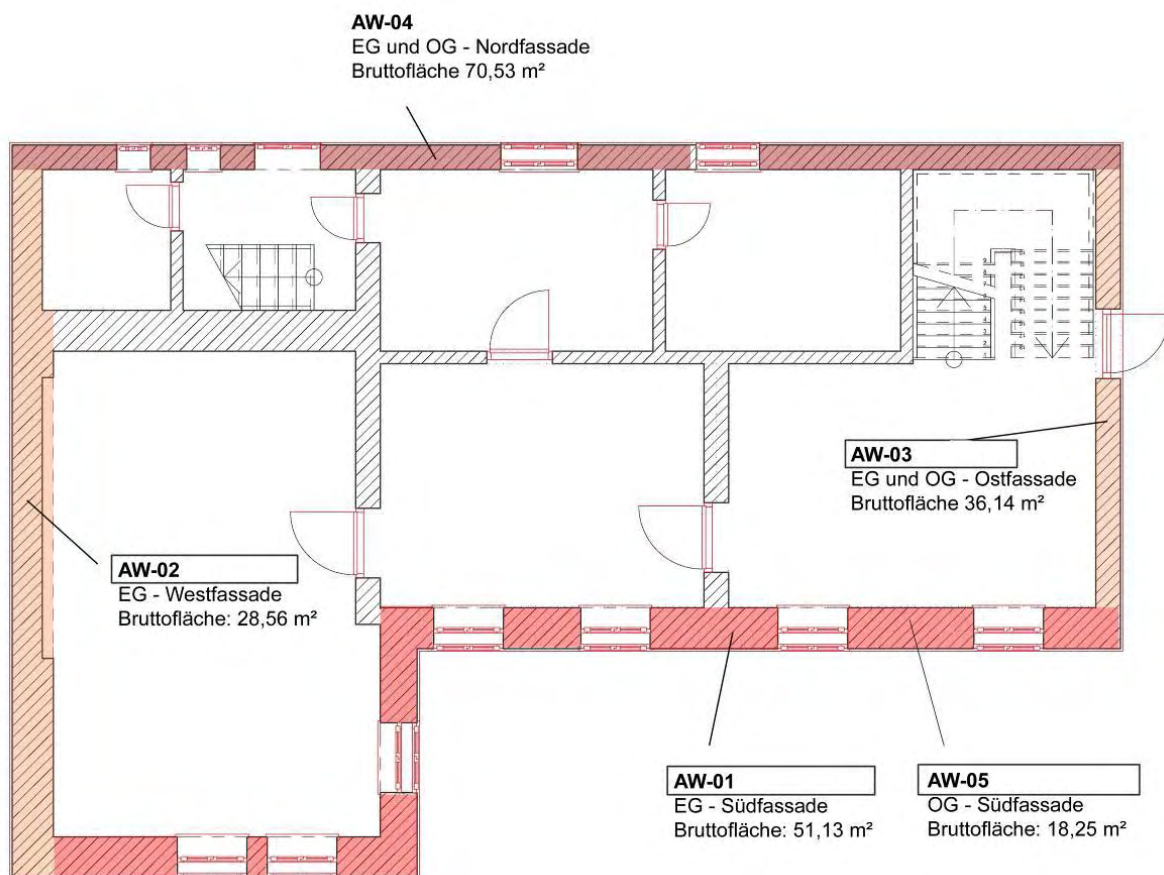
Grundrissdarstellung mit Bauteilspezifikationen
